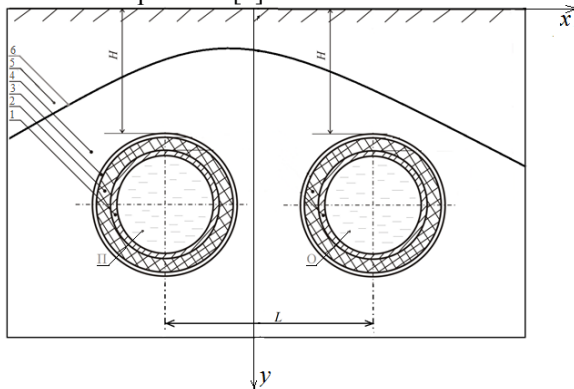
Схема поперечного сечения зоны прокладки бесканального теплопровода: 1 – металлическая стенка трубы; 2 – теплоизоляционный слой; 3 – слой гидроизоляции; 4 – грунт талый; 5 – грунт мерзлый; 6 – граница раздела между талым и мерзлым грунтом; П, О – подающий и обратный теплопроводы.
